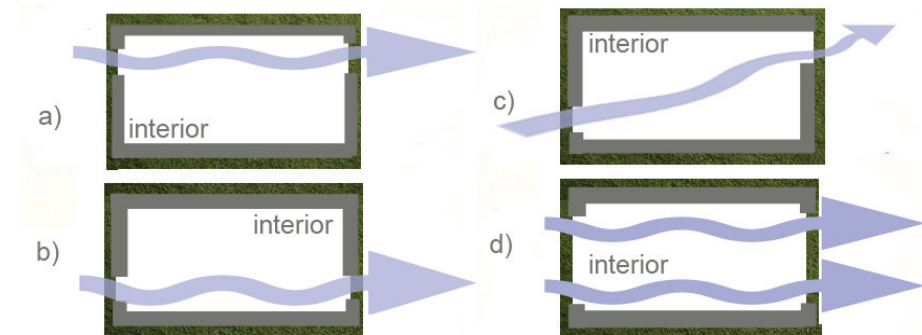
VIENTO Y APERTURAS EN FACHADAS
